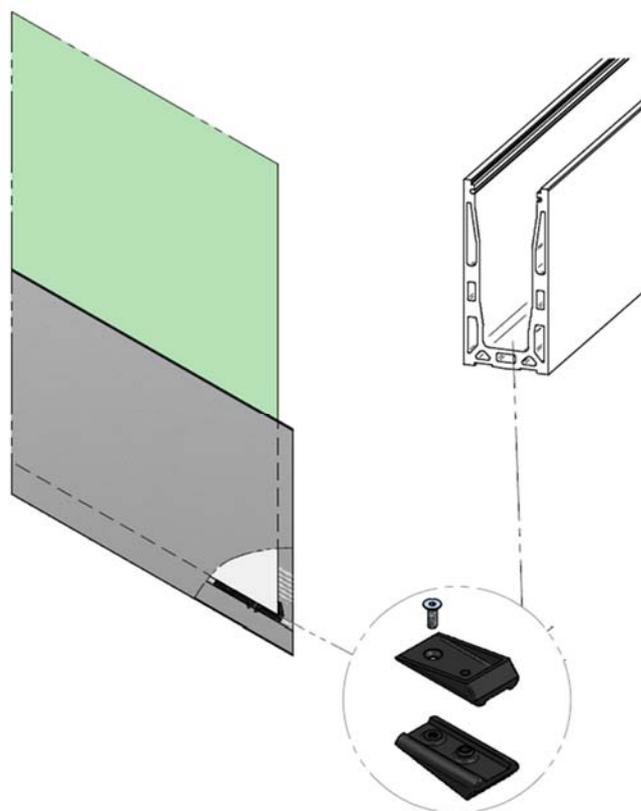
Pièce anti-glissement pour les garde-corps en rampe d'escalier
